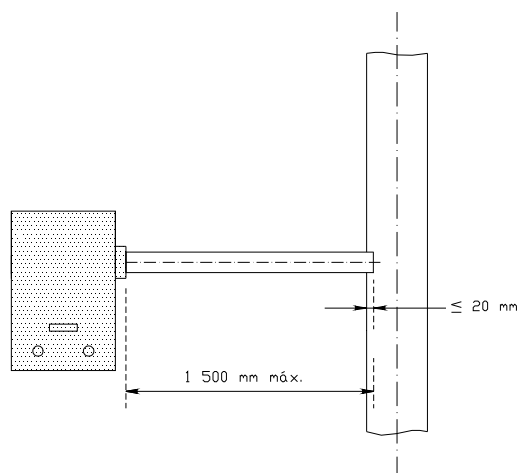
Instalação dos aparelhos de evacuação natural posterior ou lateral
